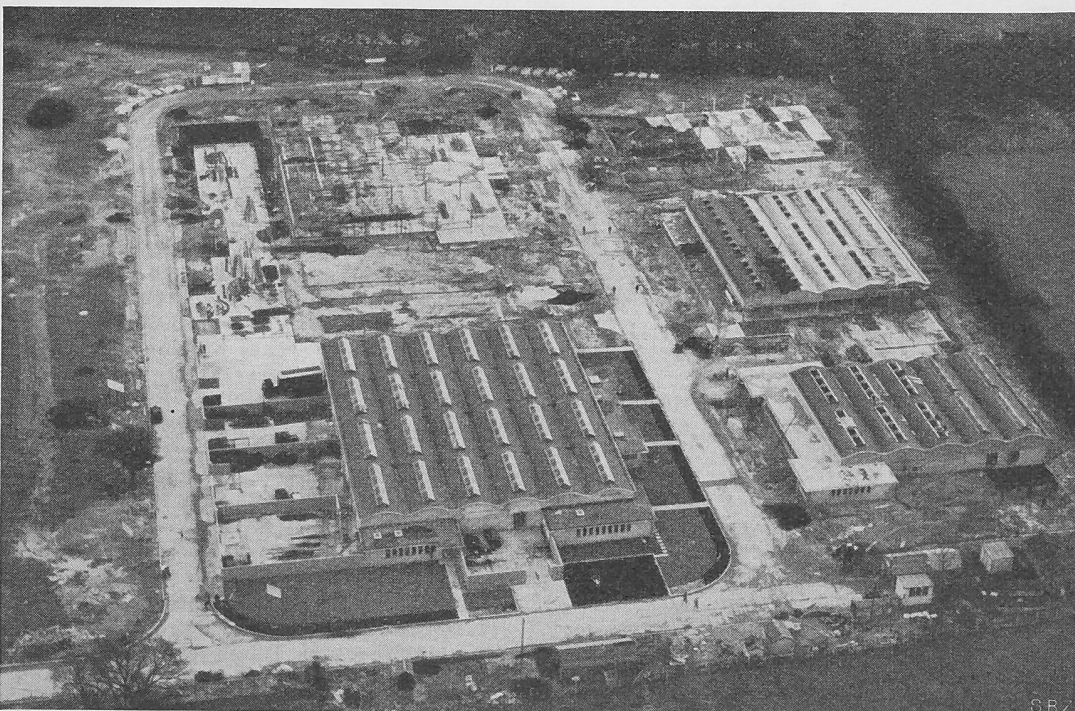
Crawley, Industriegebiet mit genormten, mietbaren Fabrikgebäuden
